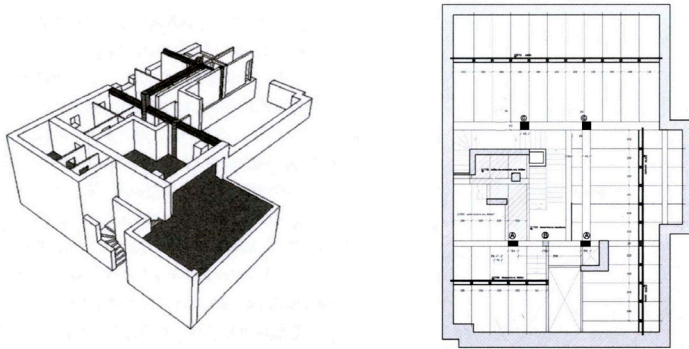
Villa Müller. Esquema estructural del suelo de la planta noble.
